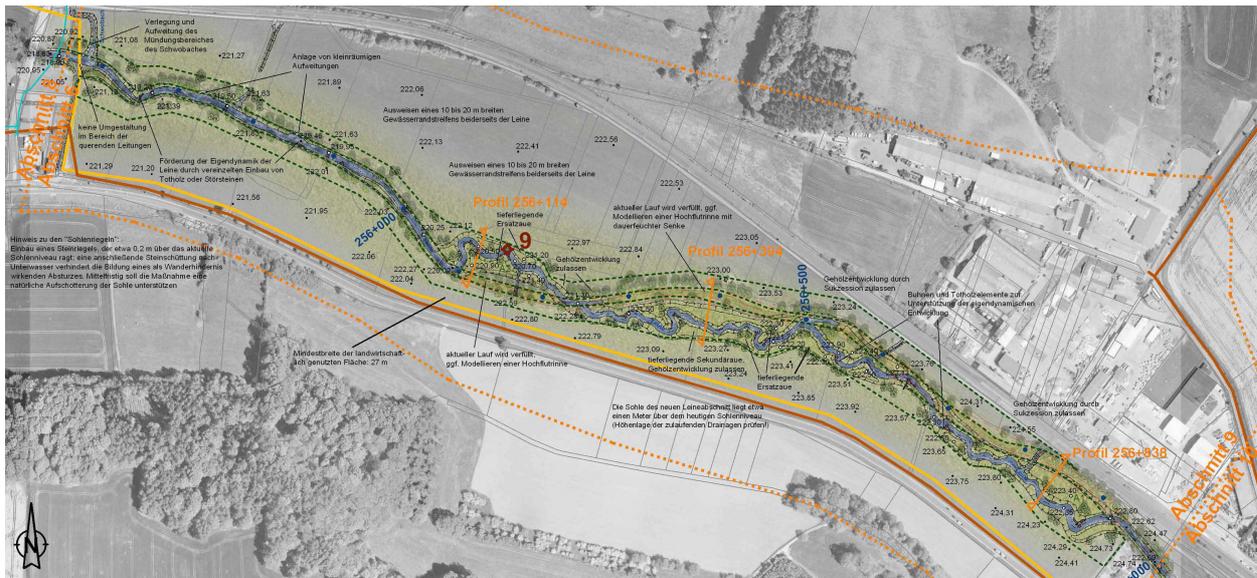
Maßnahmenabschnitt 9 in der Planung (vgl. Plan B-3-09)
